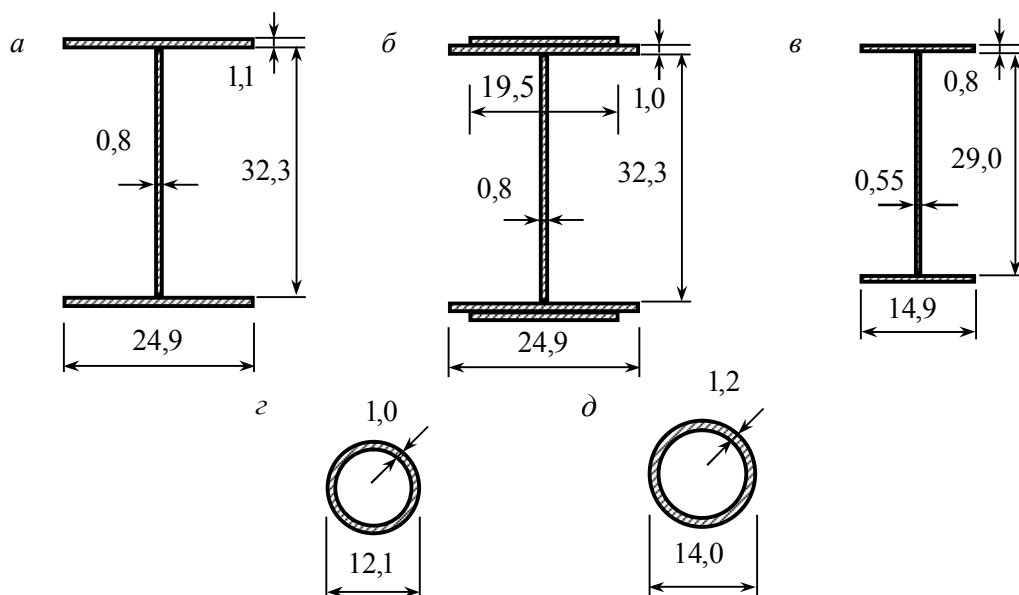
Поперечные сечения элементов конструкции покрытия (все размеры указаны в см); верхняя балка (а); верхняя балка с усилением полки (б); надколонник (в); затяжка (г); подкос (д)
